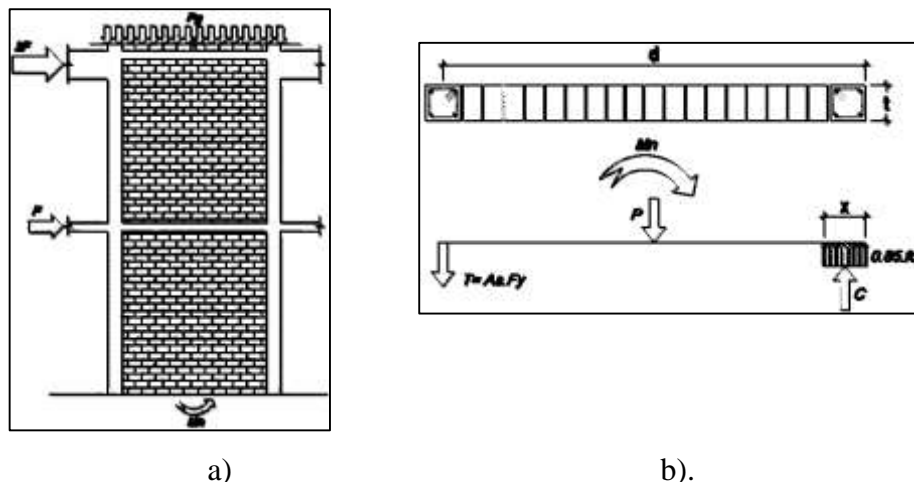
Esquema de cargas del muro a.) Cargas actuantes y b.) Sección del muro y fuerzas producidas en el muro
